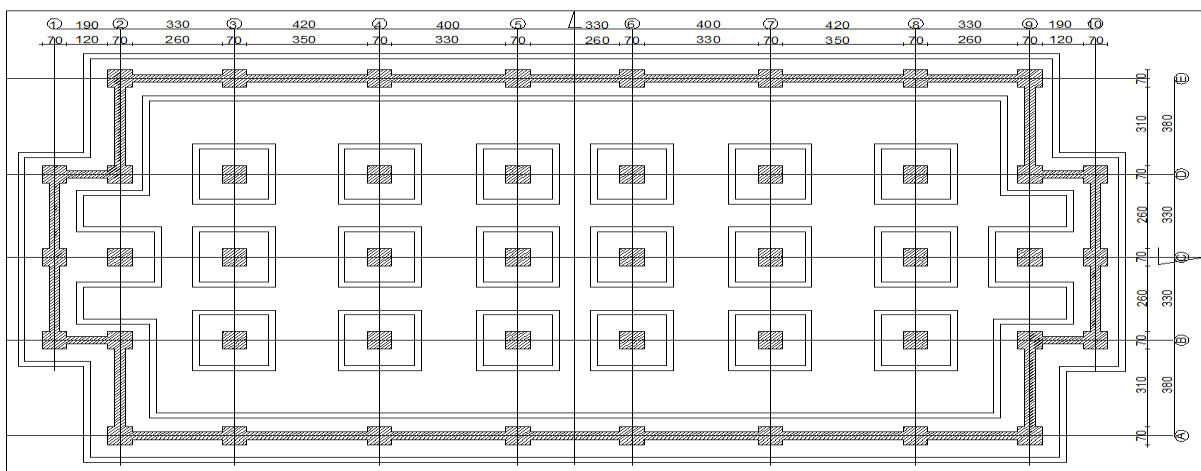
Plan de coffrage de fondation de la structure conventionnelle
